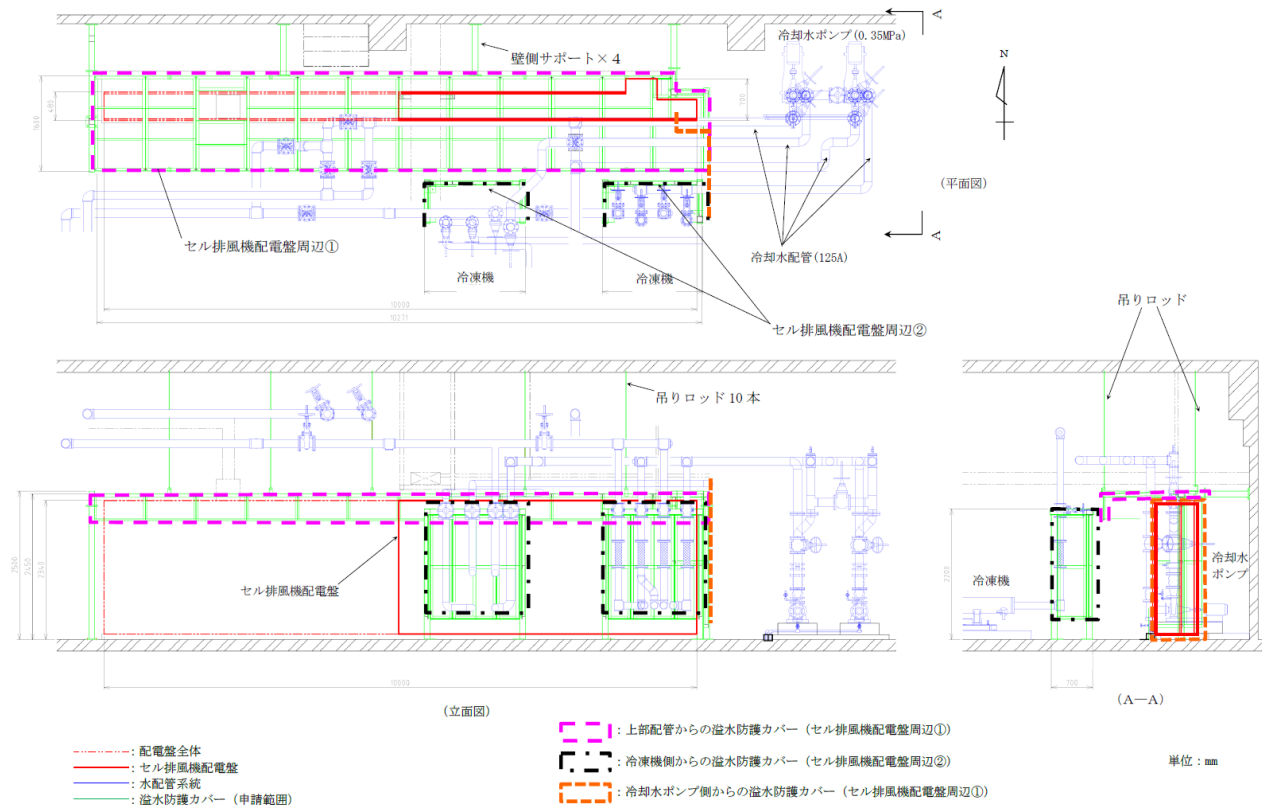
第2廃棄物処理棟コールド機械室の水源、冷凍機及び溢水防護カバー等の配置図
